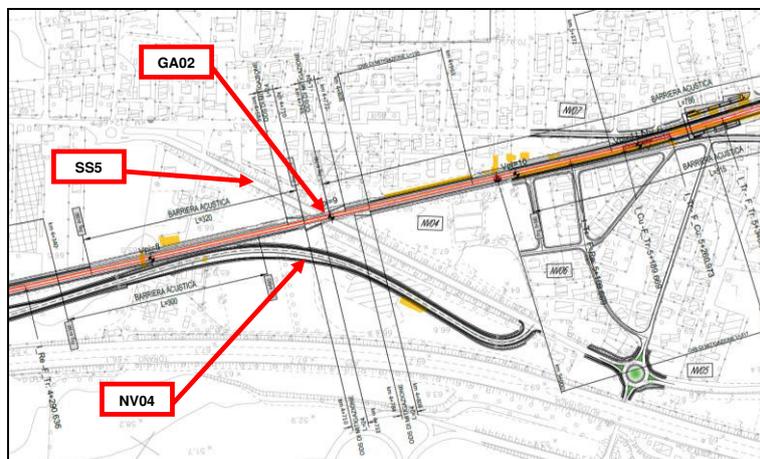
Stralcio planimetrico raddoppio di sede al km 4+739,970
